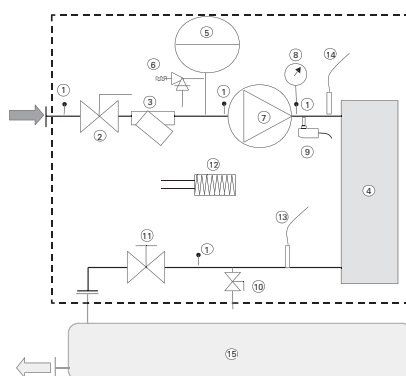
Unit zonder hydraulische module - standaard watercircuit
